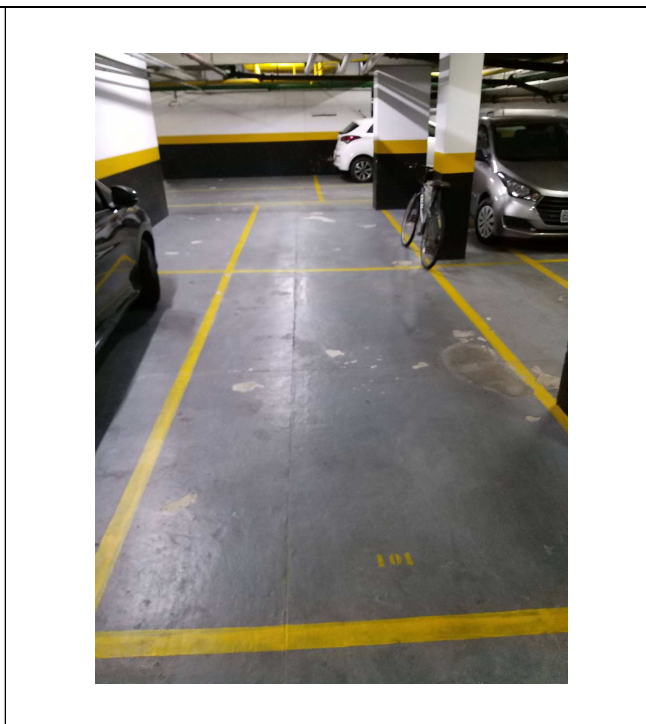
Detalhe da vaga dupla da unidade avalianda - não consta no termo de penhora
